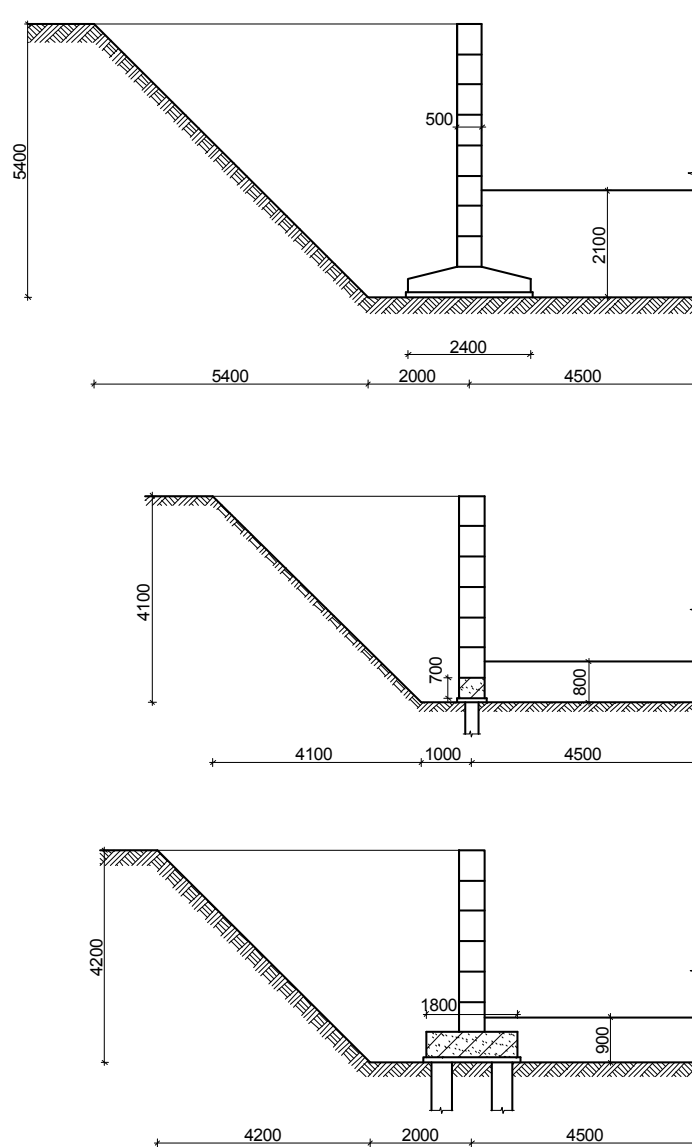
Конструктивне рішення варіантів фундаментів і поперечний переріз котлована
